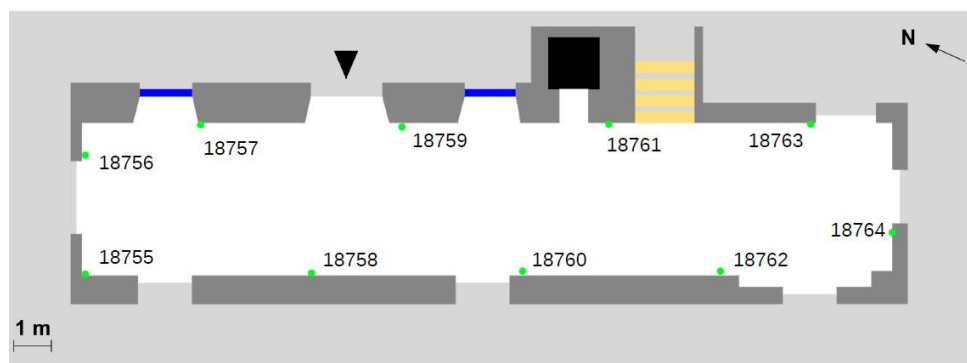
planimetria del locale Sapienza e posizionamento Beacon per test di navigazione indoor
